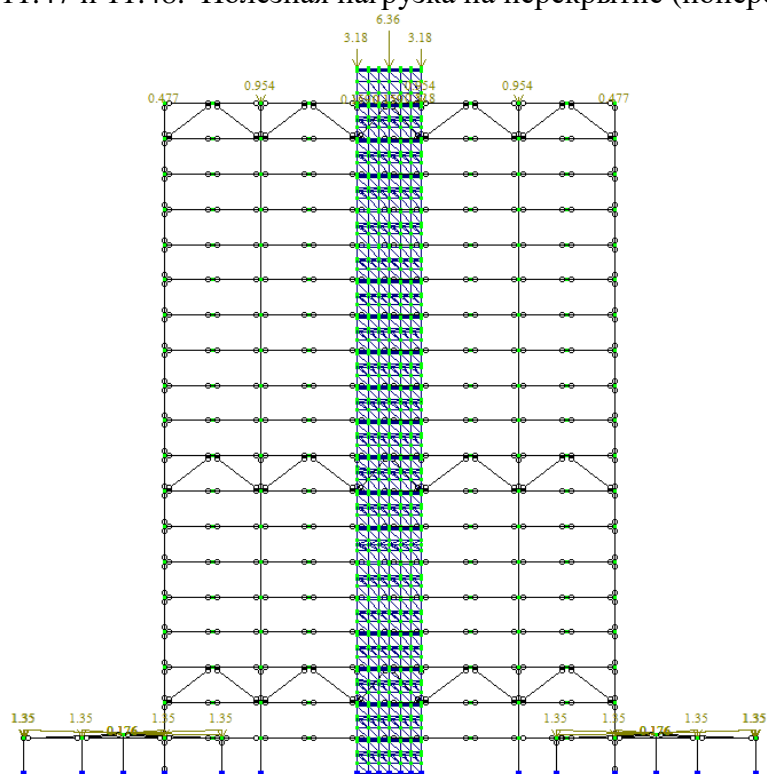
, 11.47 и 11.48. Полезная нагрузка на перекрытие (поперечный разрез)
